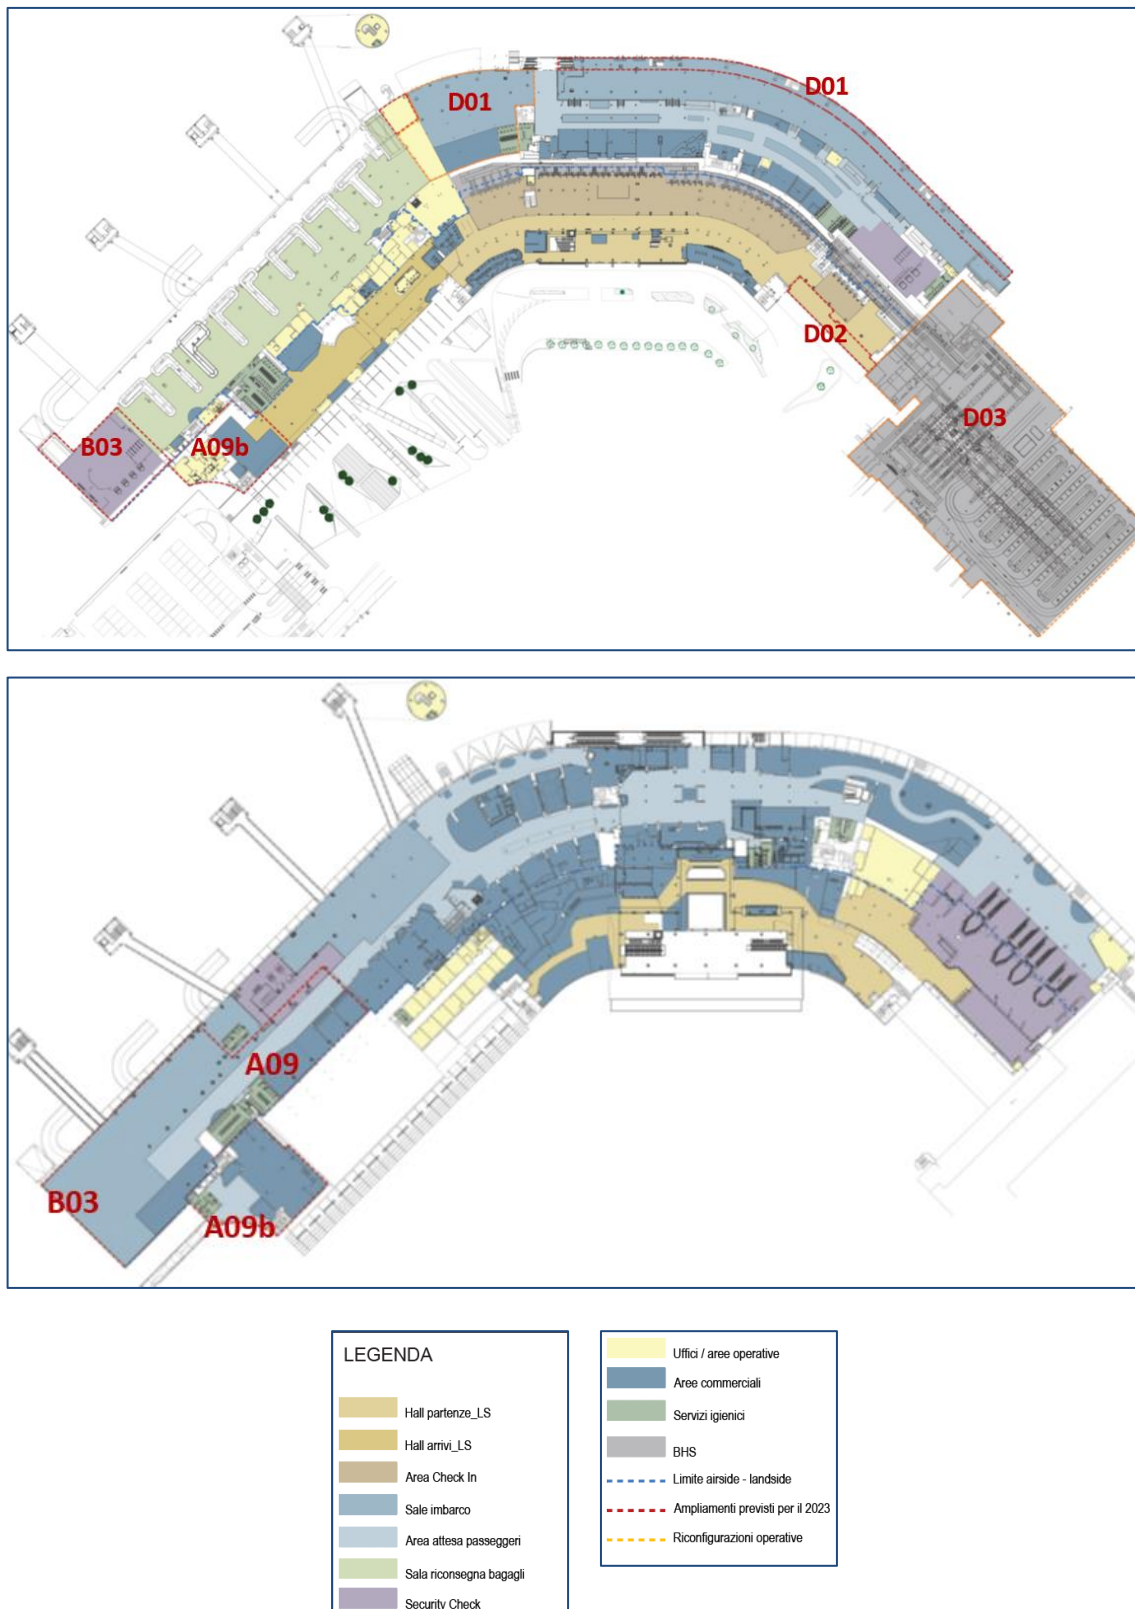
Planimetria configurazione terminal anno 2023. Piano terra e piano primo con indicazione dei codici di intervento
